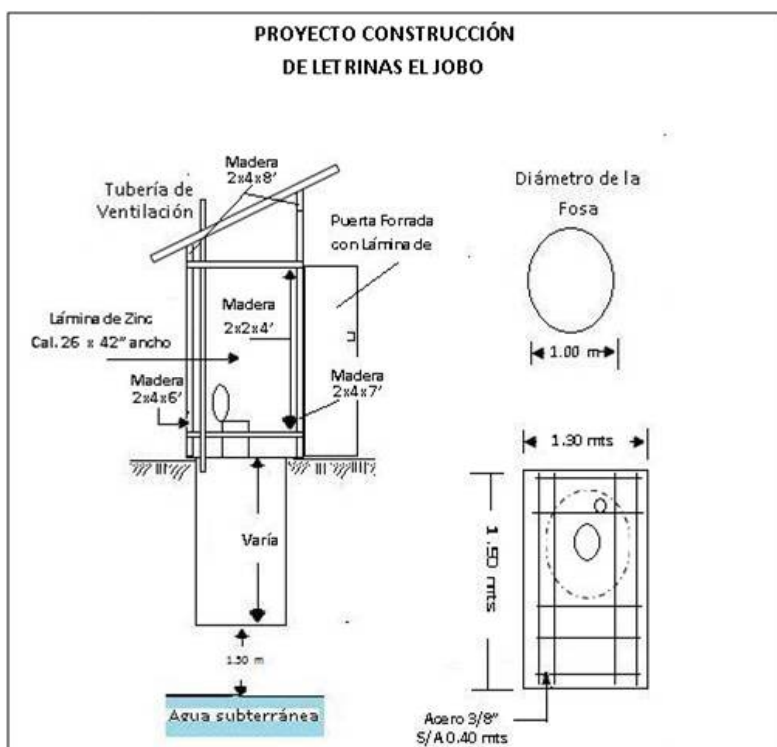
Modelo para las letrinas a construir en El Jobo y La Encantada.
